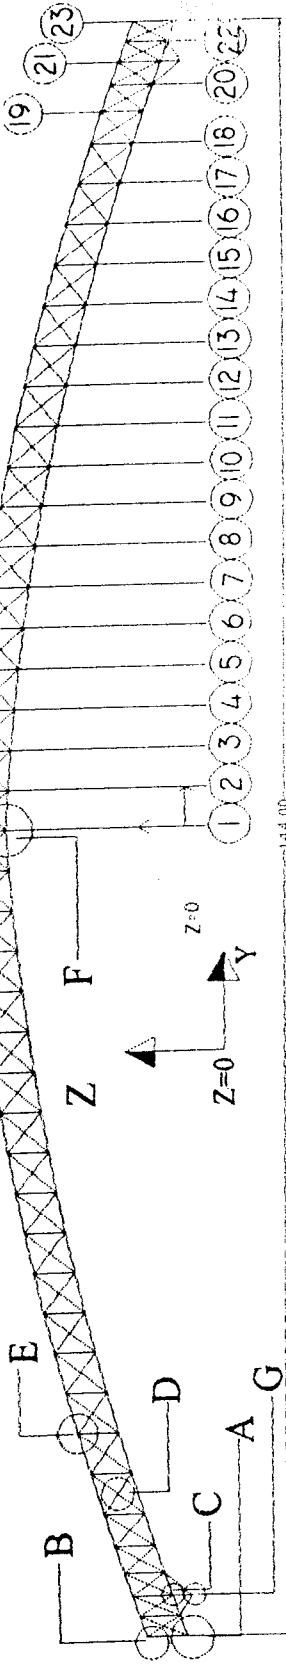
DENAH TAMPAK ATAS KUDA-KUDA
